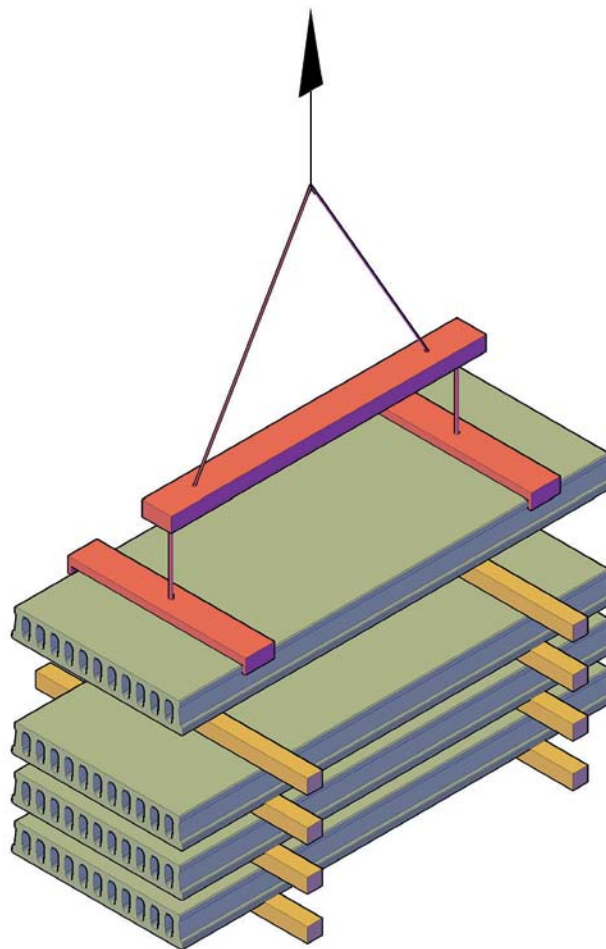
Схема складирования, подъема и транспортировки многопустотных плит перекрытия.
